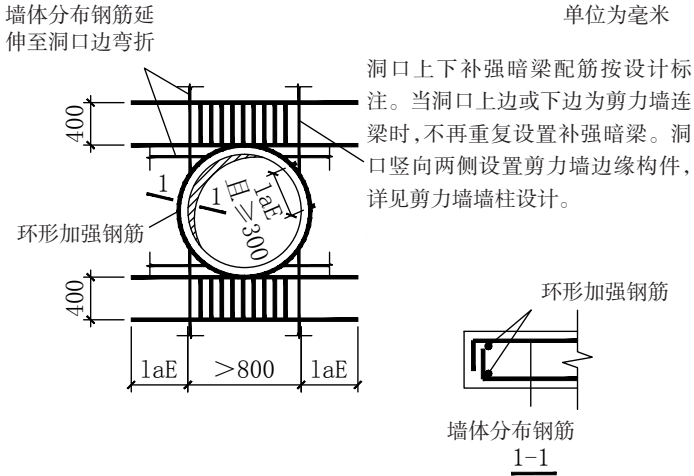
剪力墙圆形洞口直径大于800mm时补强钢筋构造
